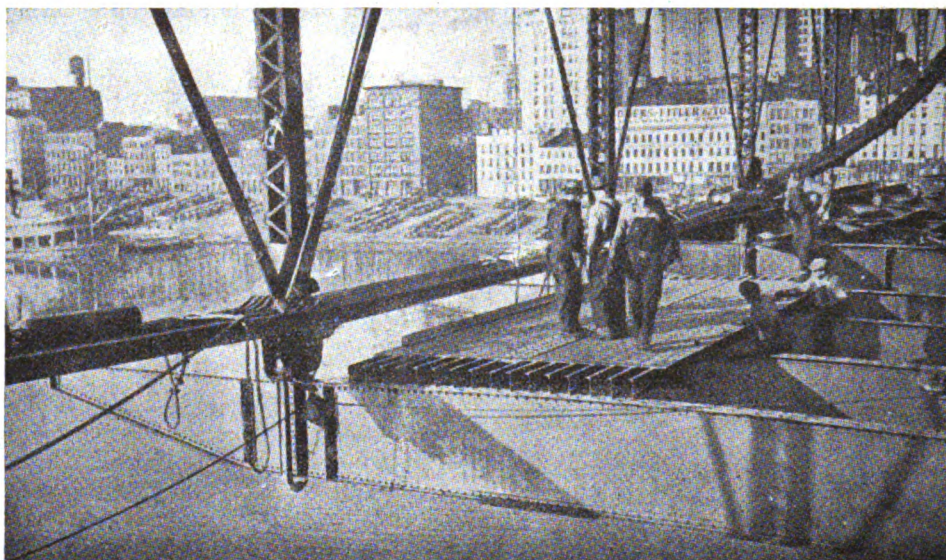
Armatura di pavimento di un ponte, costituita da un ferro a U e lamiere di lega d'alluminio.
